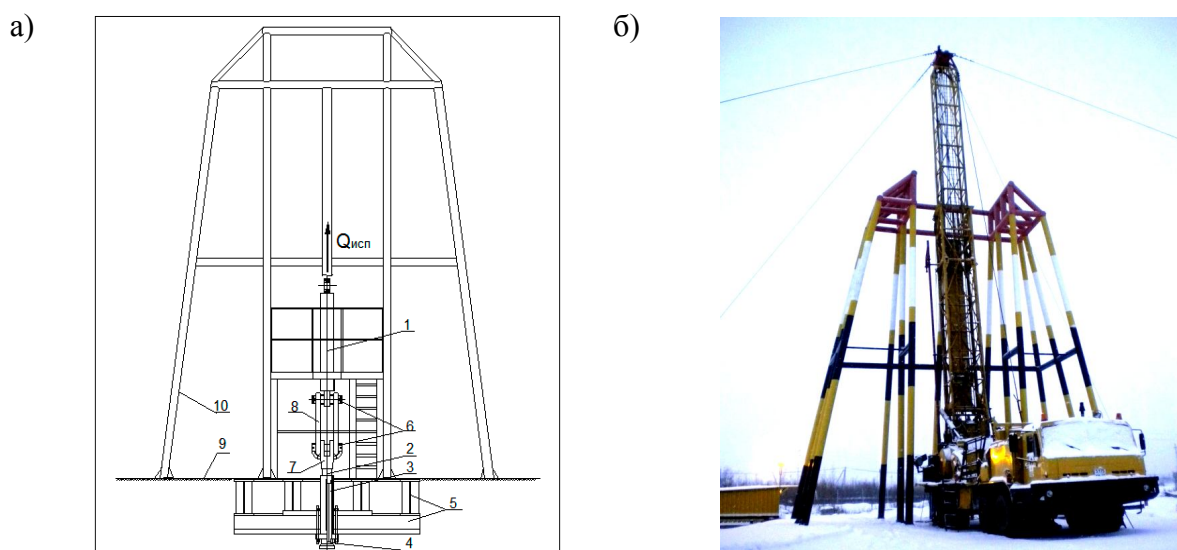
Общий вид (а) и фото (б) установочной площадки испытательного стенда: 1 – гидроцилиндр, 2 – переходник, 3 – центральный якорь, 4 – планшайба, 5 – усиление из двутавровых балок, 6 – палец, 7 – серьга, 8 – шарнирная сцепка, 9 – площадка обслуживания, 10 – опоры ограждения.
